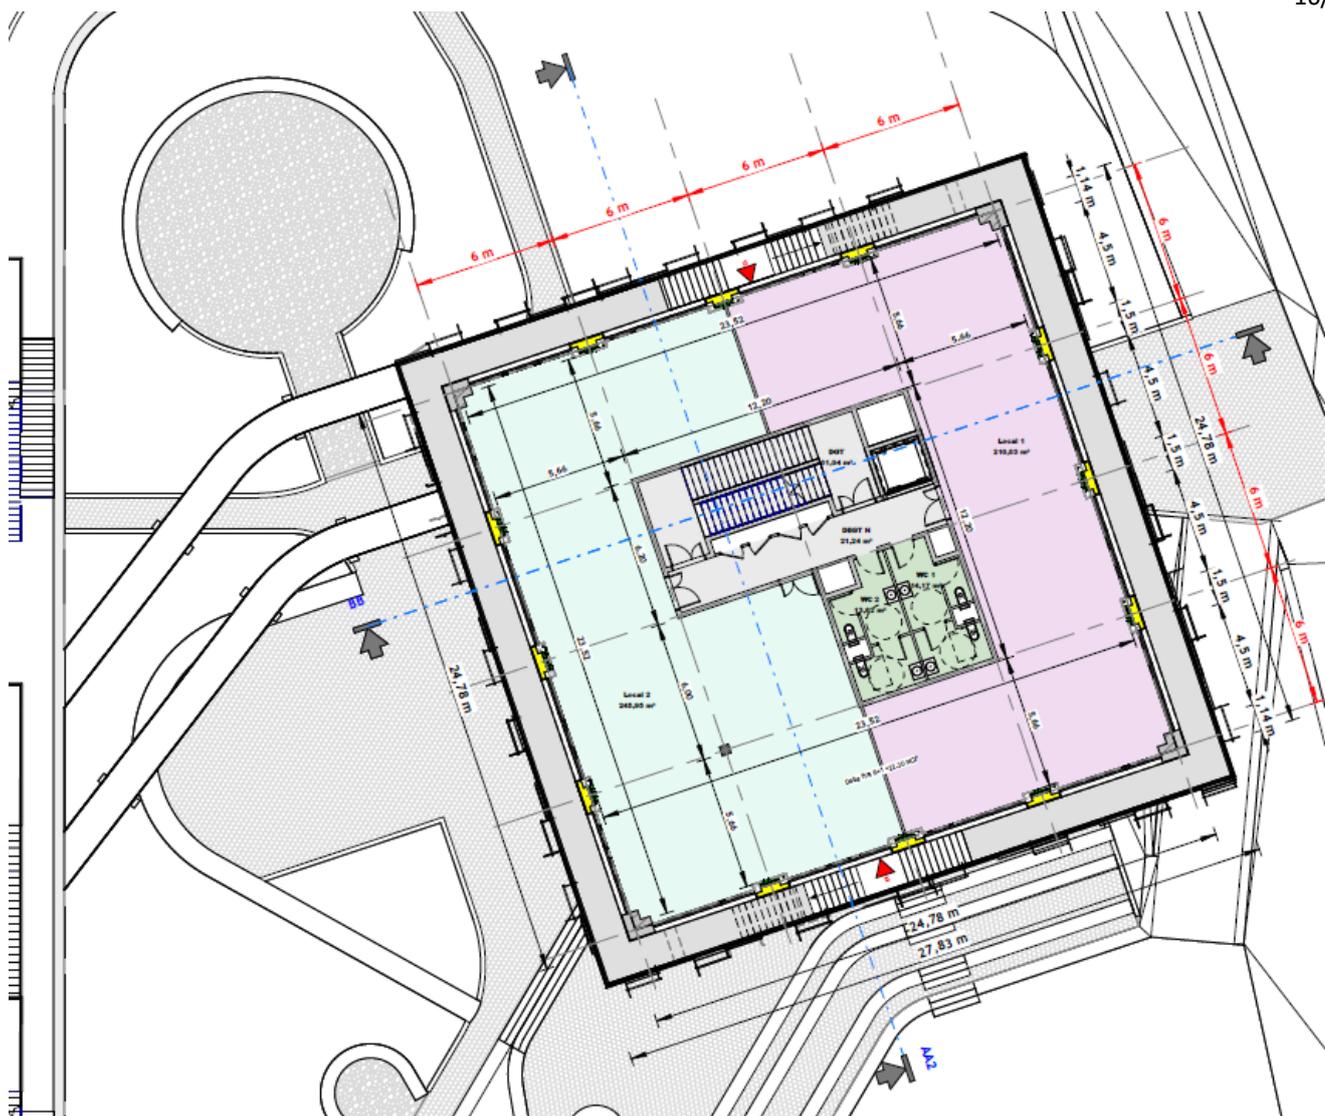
Plan de pavillon – niveau R+1 (février 2024)
